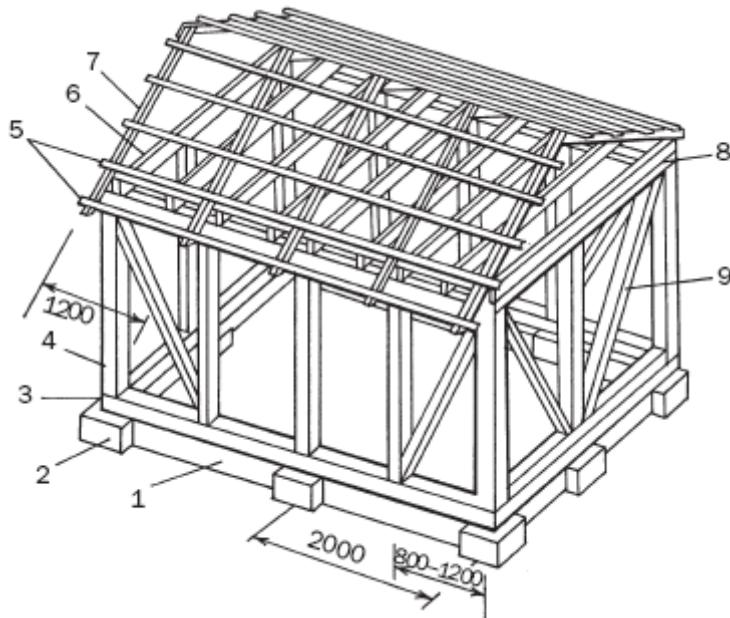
Дом каркасной конструкции: 1 – стенка; 2 – столб фундамента; 3 – нижняя обвязка; 4 – стойка; 5 – обрешетка; 6 – балка чердачного перекрытия; 7 – стропильная нога; 8 – верхняя обвязка; 9 – раскос
